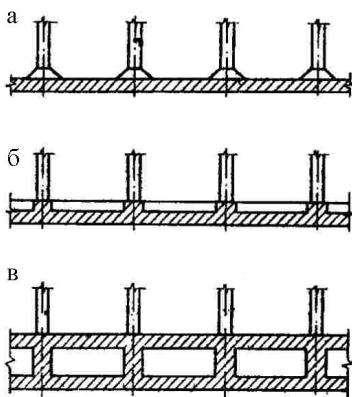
Суцільні залізобетонні фундаменти:
